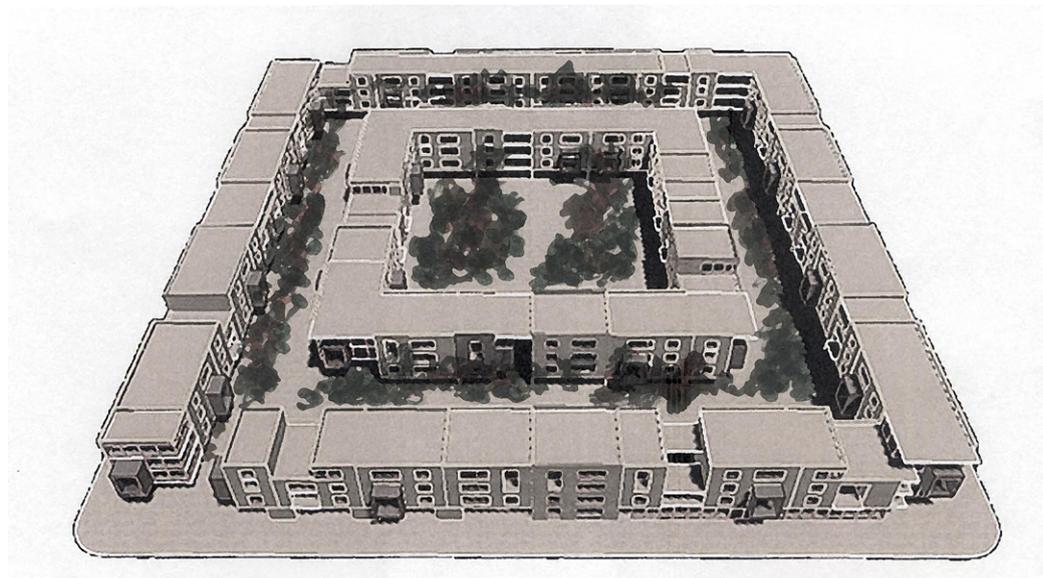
| Prefiguración del bloque manzana. Fuente: elaboración propia.
